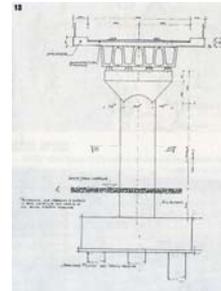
Section type et détails du nouveau viaduc de la RD 78 sur le Tanaro
